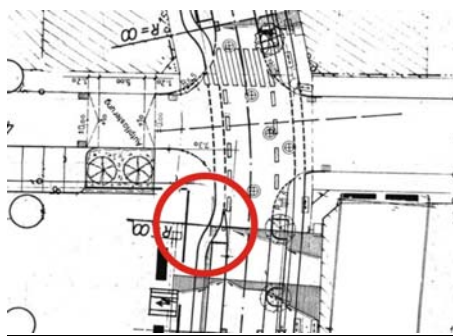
Lageplan „Sichtbehinderung zu Fußgängern durch parkende Fahrzeuge“
